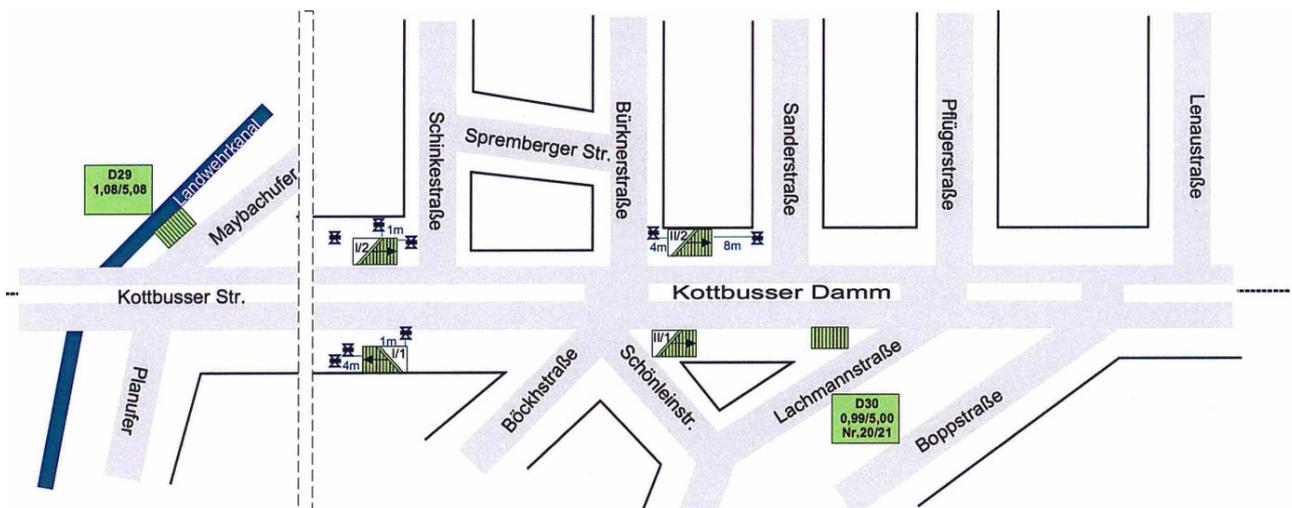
Ausschnitt vom Lageplan für den U-Bahnhof Schönleinstraße mit Darstellung der umgebenden Straßen und der Zugänge zum U-Bahnhof
